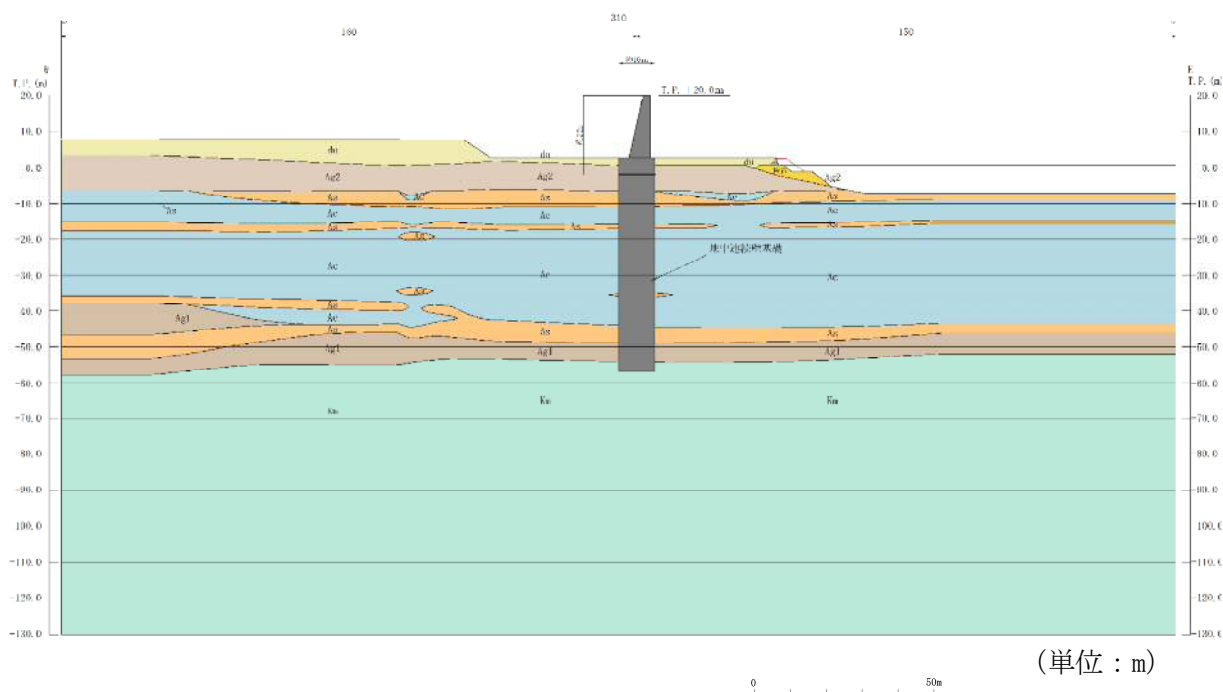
(6) 鉄筋コンクリート防潮壁 断面図(F-F断面)
